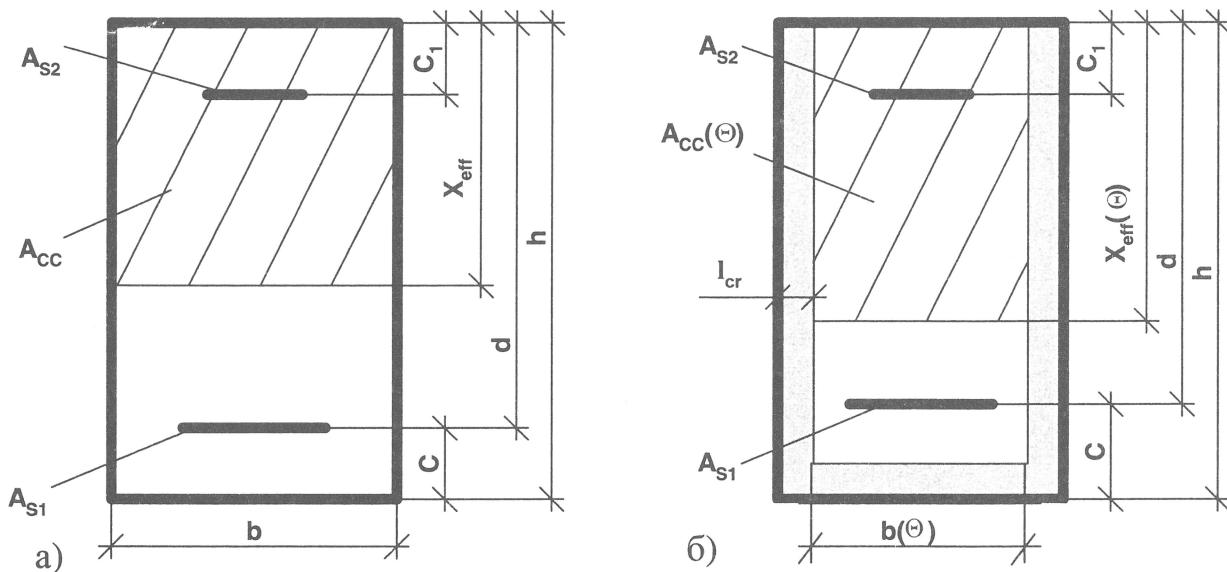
Расчетные параметры изгибающей железобетонной конструкции
